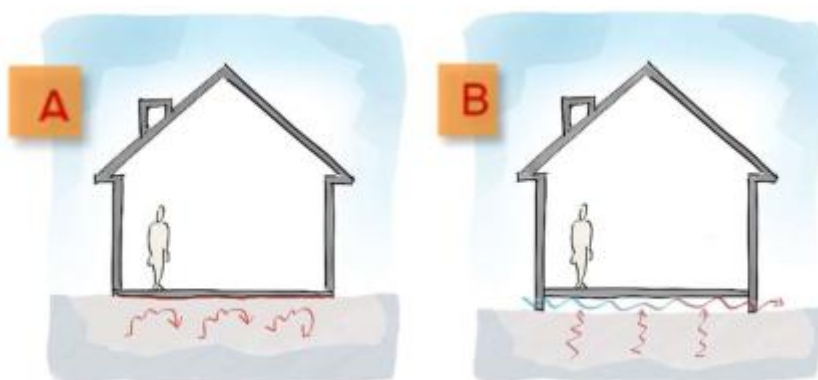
Barrera de protección (A) y cámara de aire ventilada (B). Fuente: [49].
